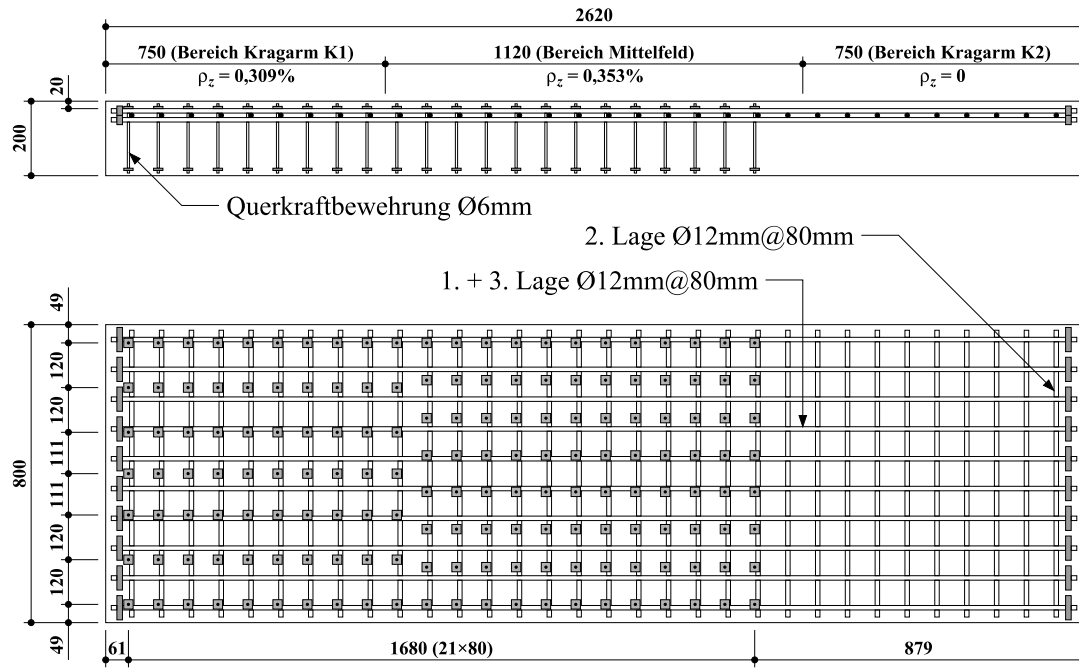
Bewehrungslayout des Plattenstreifens, entnommen aus [1]
